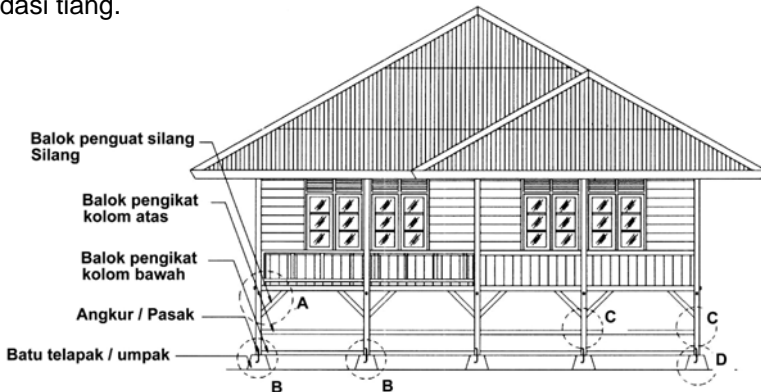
Detail hubungan balok sloof dengan kolom tengah dan silang pengaku
